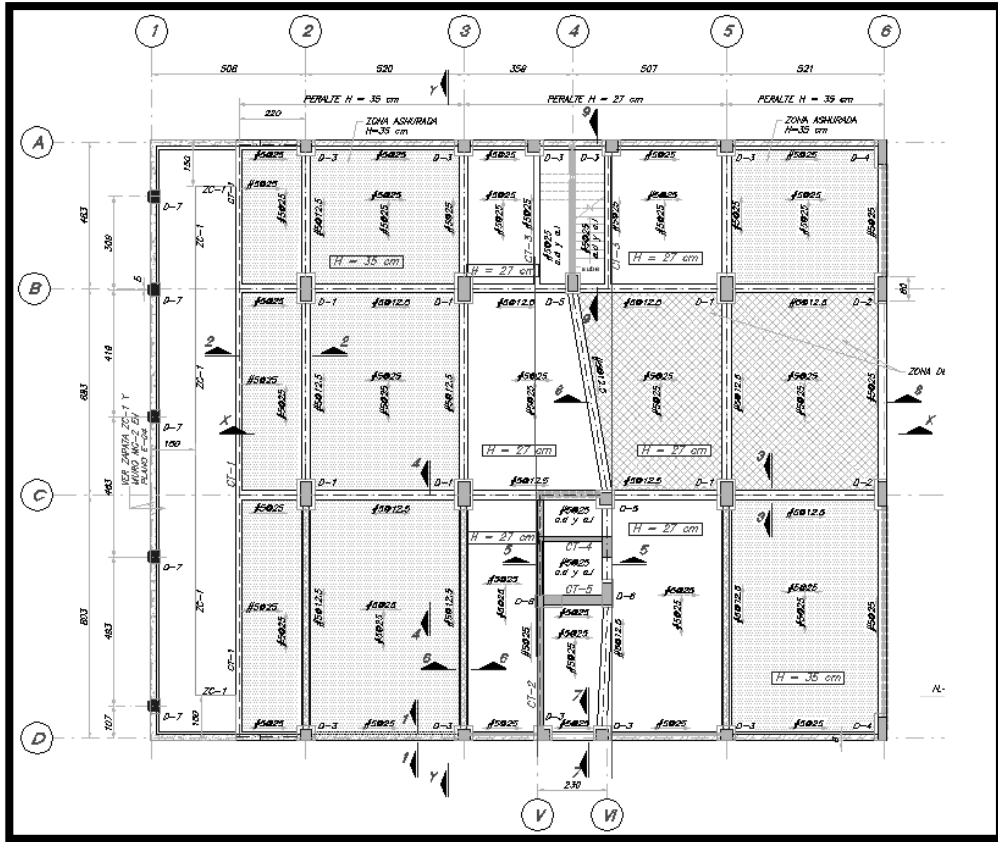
Planta estructural de losa de fondo de cajón de cimentación.
